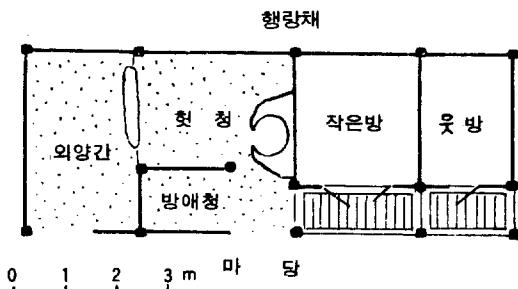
范里의 鄭成漢氏宅 行랑채 平面図
